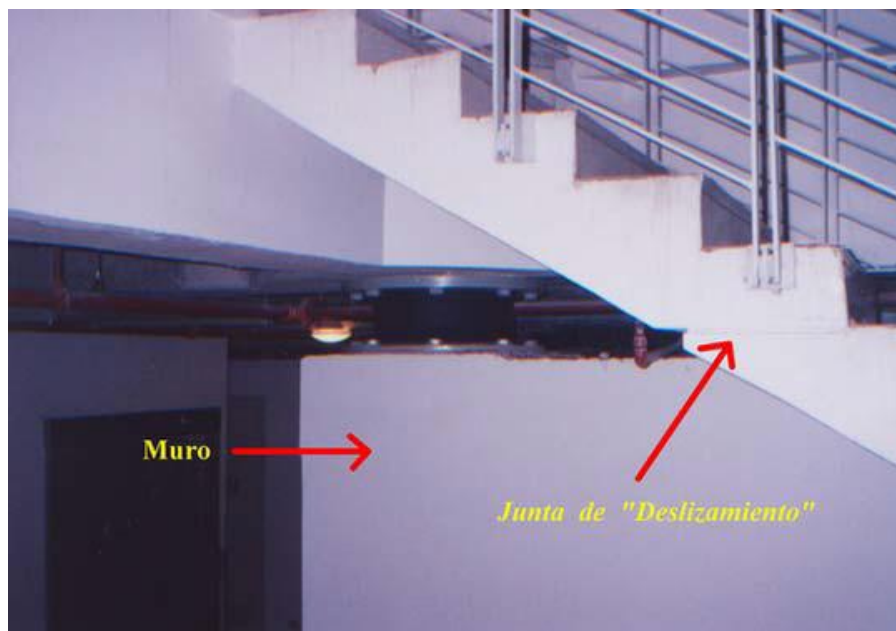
c. Junta deslizante, conexión escalera-superestructura.
